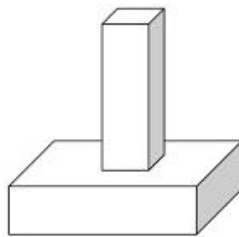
8 Model apartemen berbentuk Single tower (Apartments: Their Design and Development, Samuel Paul, 1968)
